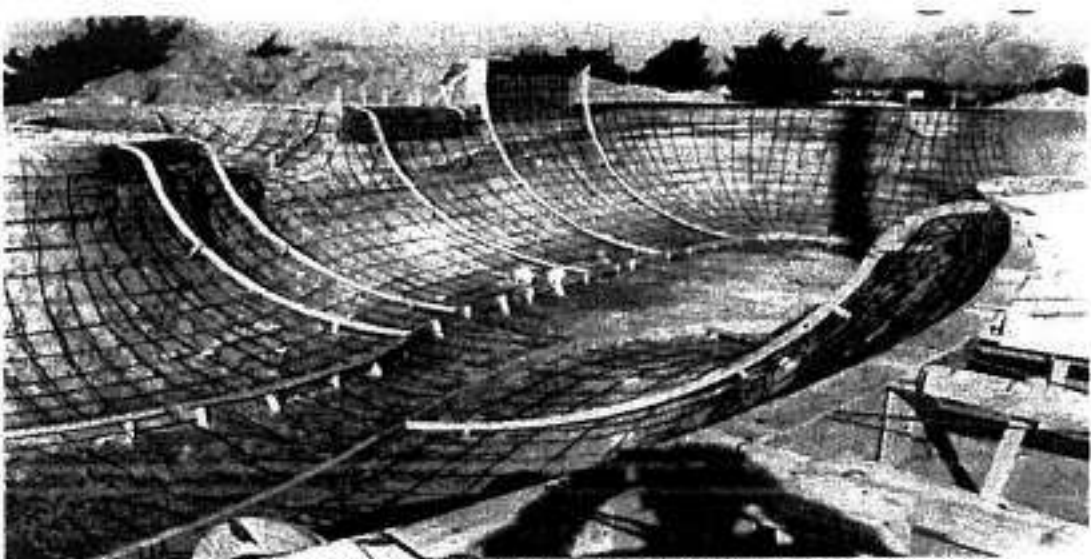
Demonstração da escolha e montagem dos painéis de uma pista construída nos EUA
